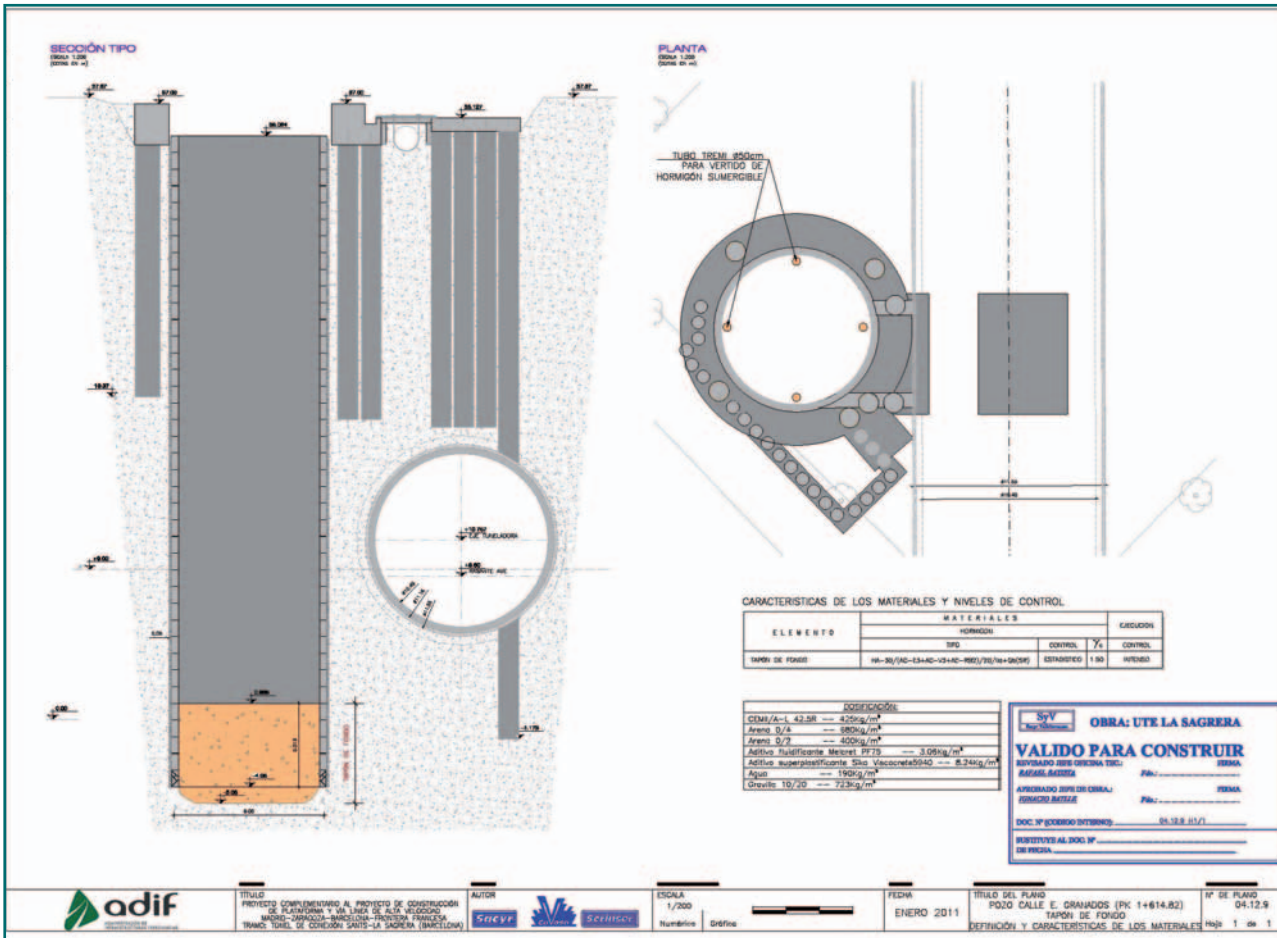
Tapón de fondo. Diseño y puesta en obra del concreto/Bottom plug. Design and concreting.
